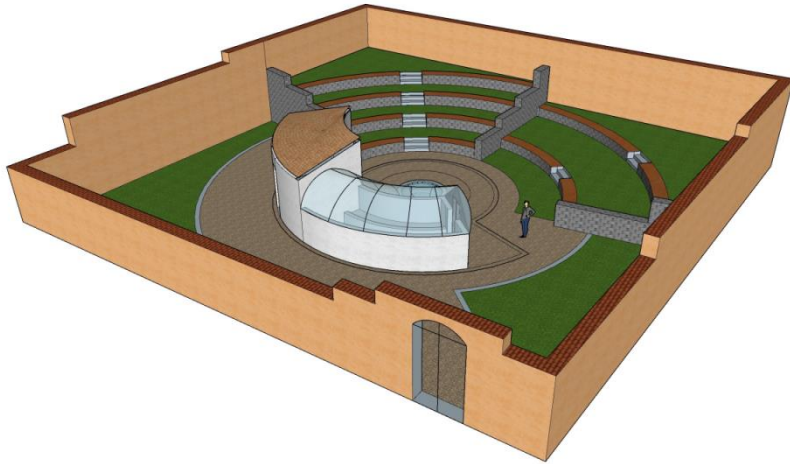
Vista aérea estado propuesto. Fuente propia.
